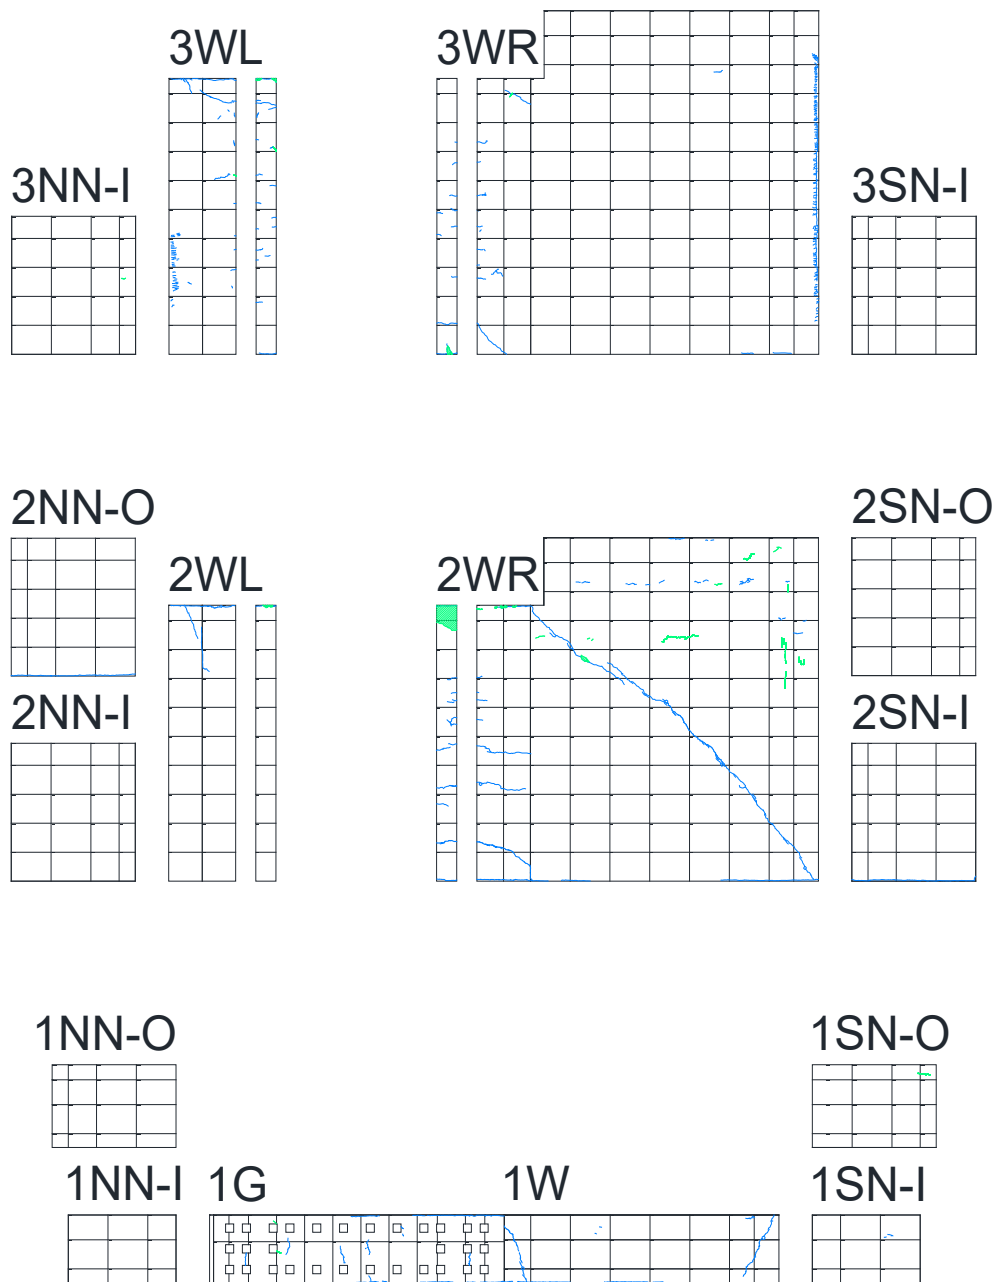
耐力壁および直交壁のひび割れ推移 サイクル:1/1600
